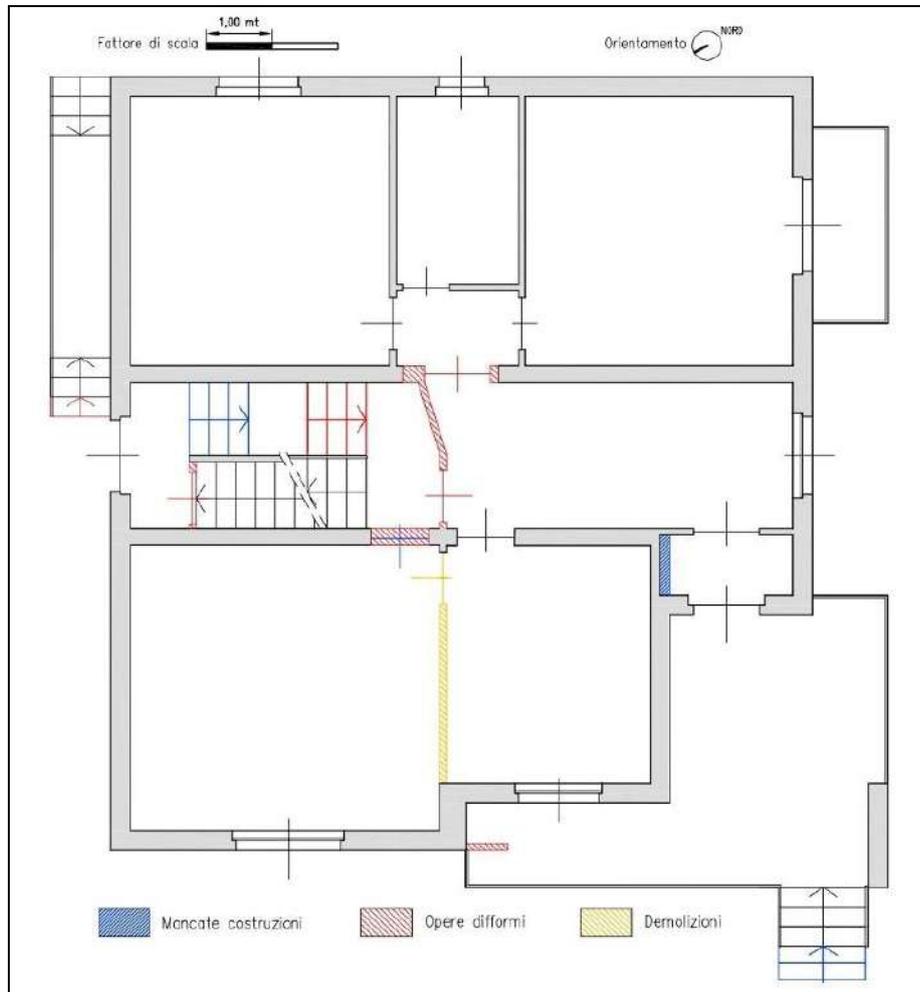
Pianta piano rialzato - confronto con la planimetria catastale ultima in atti
